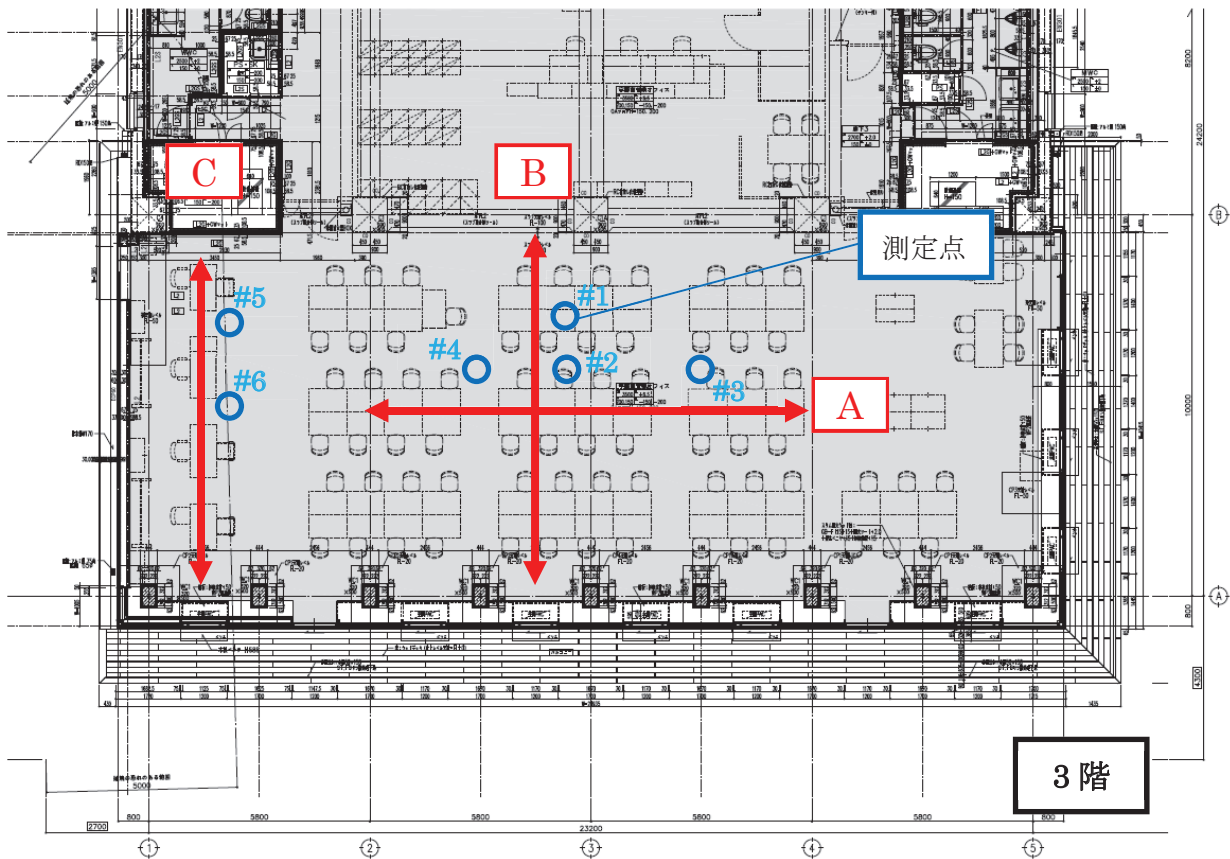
3 階平面図 測定位置及び加振歩行経路
